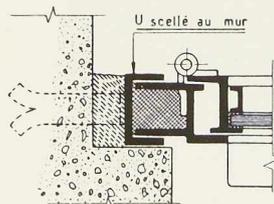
Détail de fixation d'un châssis au droit d'un joint de dilatation.
